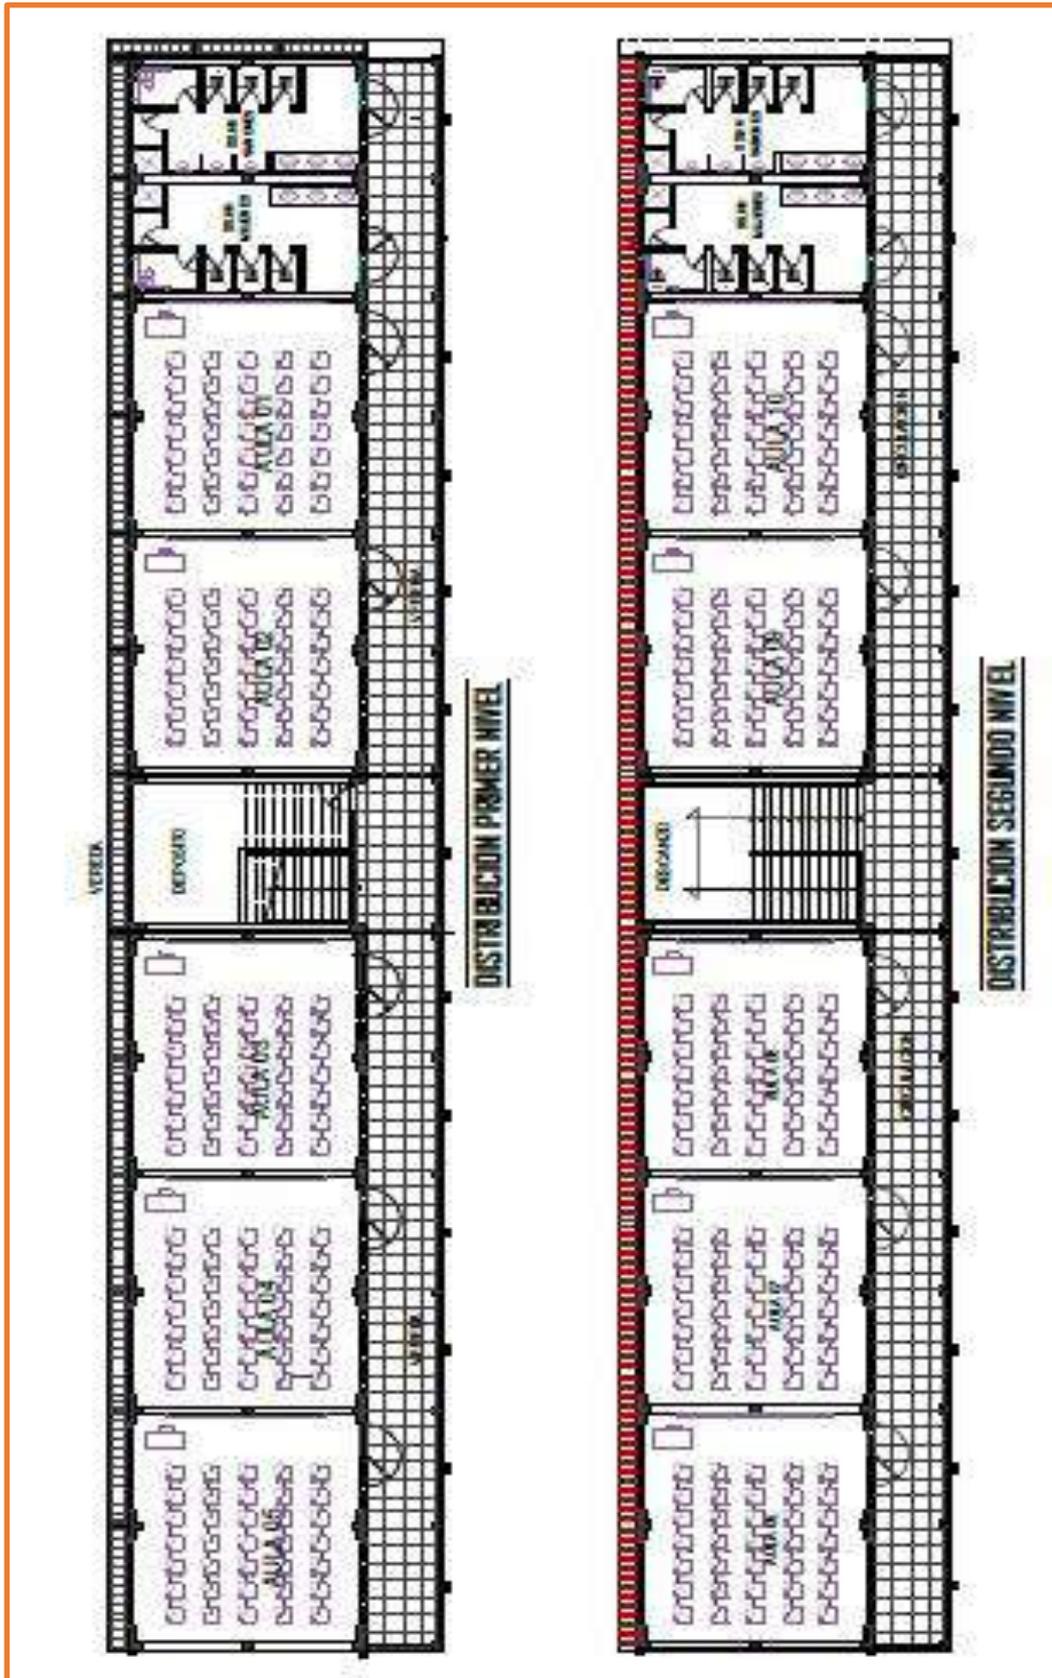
Diseño Arquitectónico –Segunda Planta
